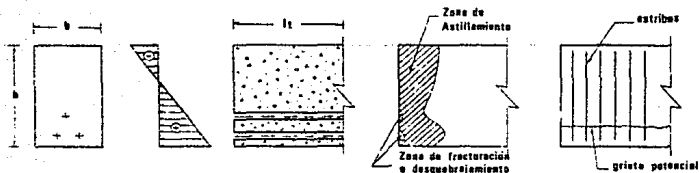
a) Sección transversal de una viga prefabricada. b) Bloque de esfuerzos provocado por la acción horizontal del prefuerzo en el sentido transversal de la viga. c) Transmisión de la fuerza de prefuerzo al concreto. d) Zona astillada por la acción del prefuerzo y el resquebraje potencial del extremo. refuerzo requerido.
